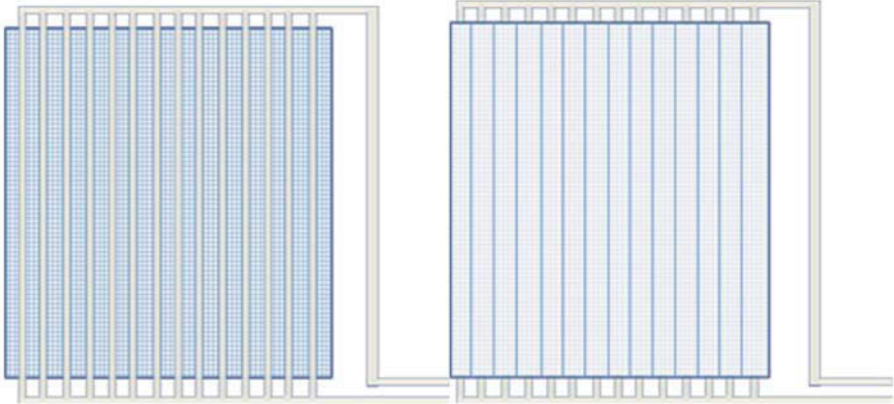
Thermisch aktive Wandsysteme; links: Typ 1, Gewebe mit integrierten Schläuchen und den Anschlussrohren, rechts: Typ 2, beschichtetes Gewebe mit ultraschallgeschweißten Kanälen und den Anschlussrohren
